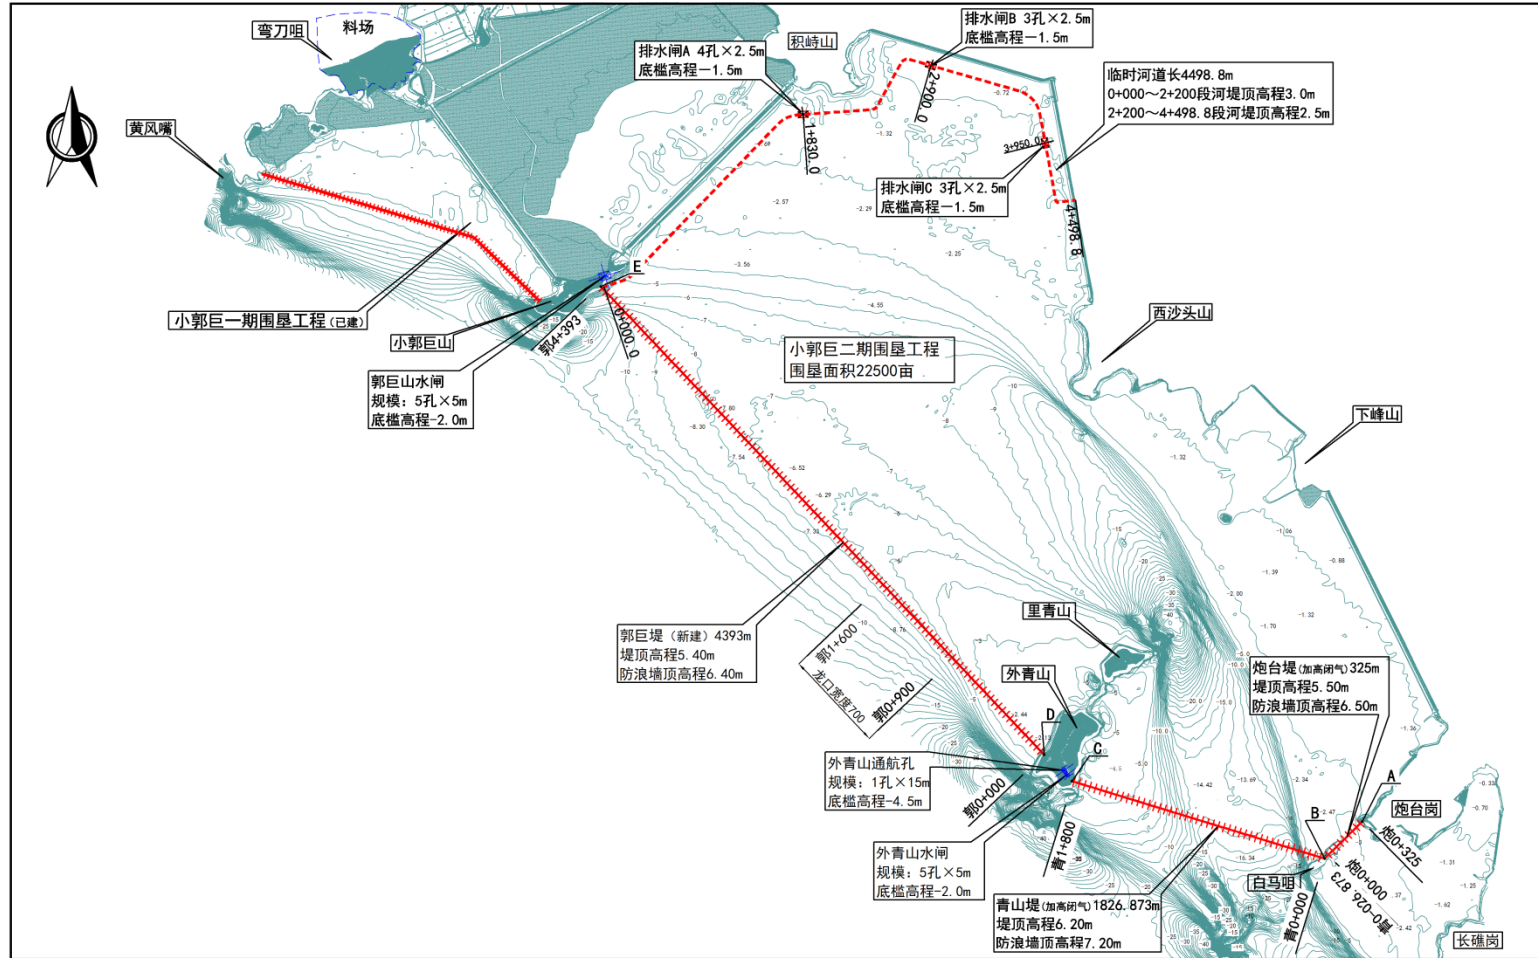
舟山市六横小郭巨二期围垦工程平面布置示意图
